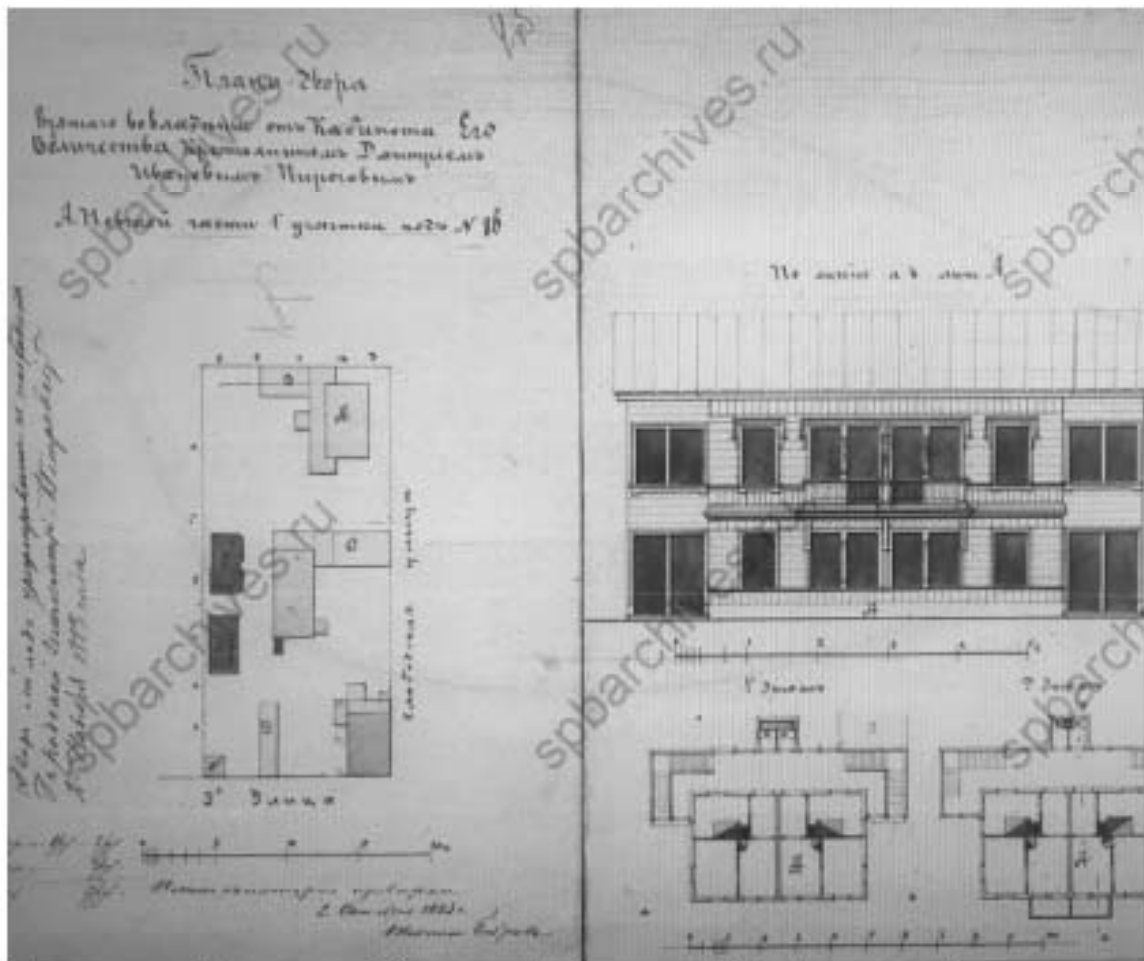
План участка, фасады зданий по адресу Глазурная ул., 9/Слободская ул., 8
